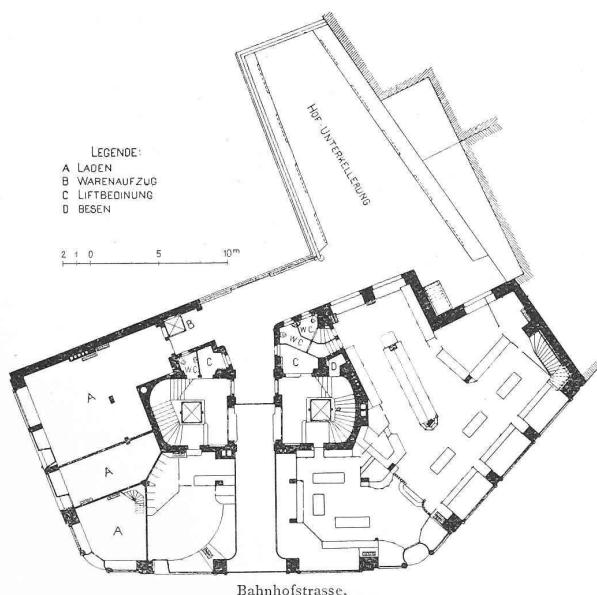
Grundriss vom Erdgeschoss. — Masstab 1:500.
